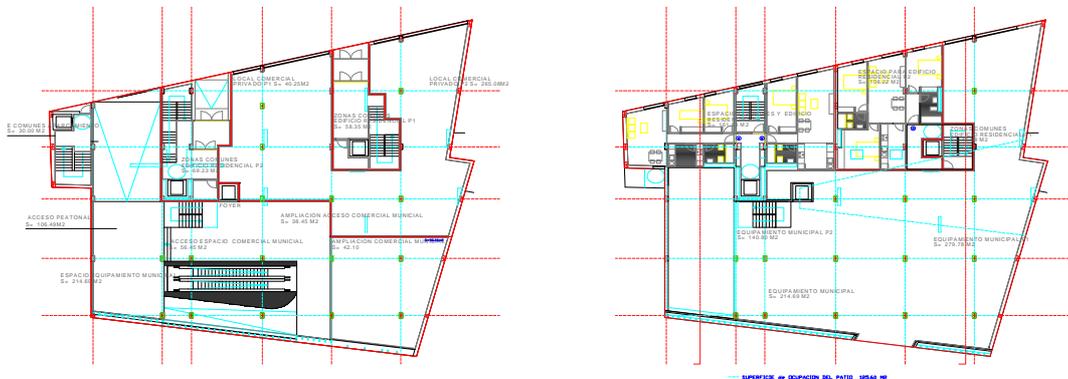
OBRAS EN PLANTA BAJA Y PRIMERA
